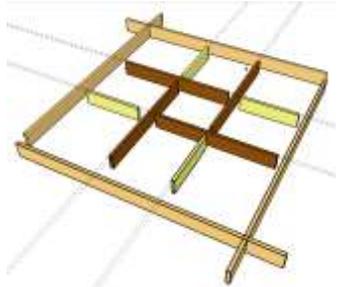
Vigas en esvástica. Fuente: elaboración propia.
